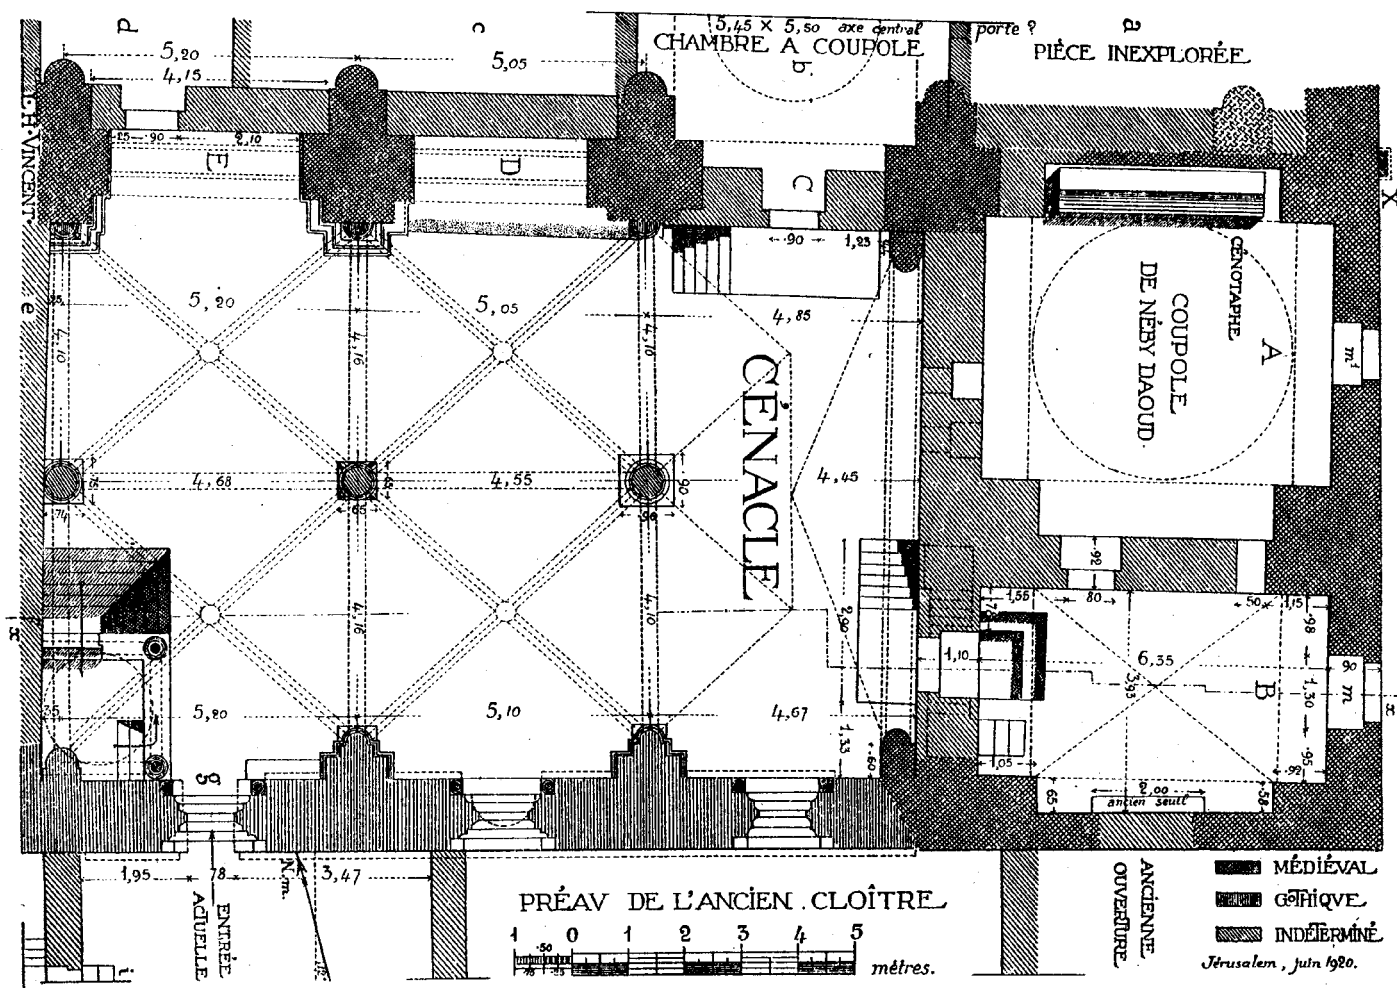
Pianta del S. Cenacolo (piano superiore).
